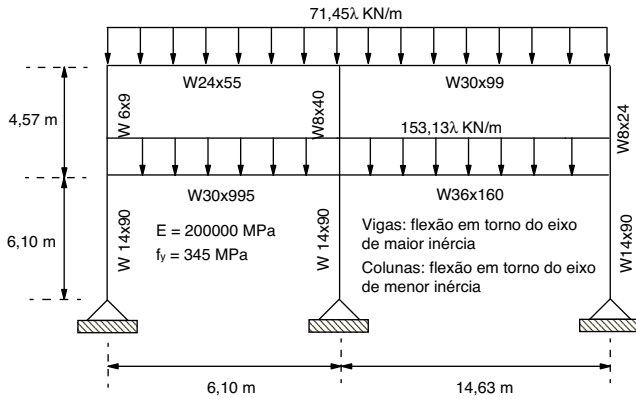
Pórtico de 2 andares: geometria e carregamento.
